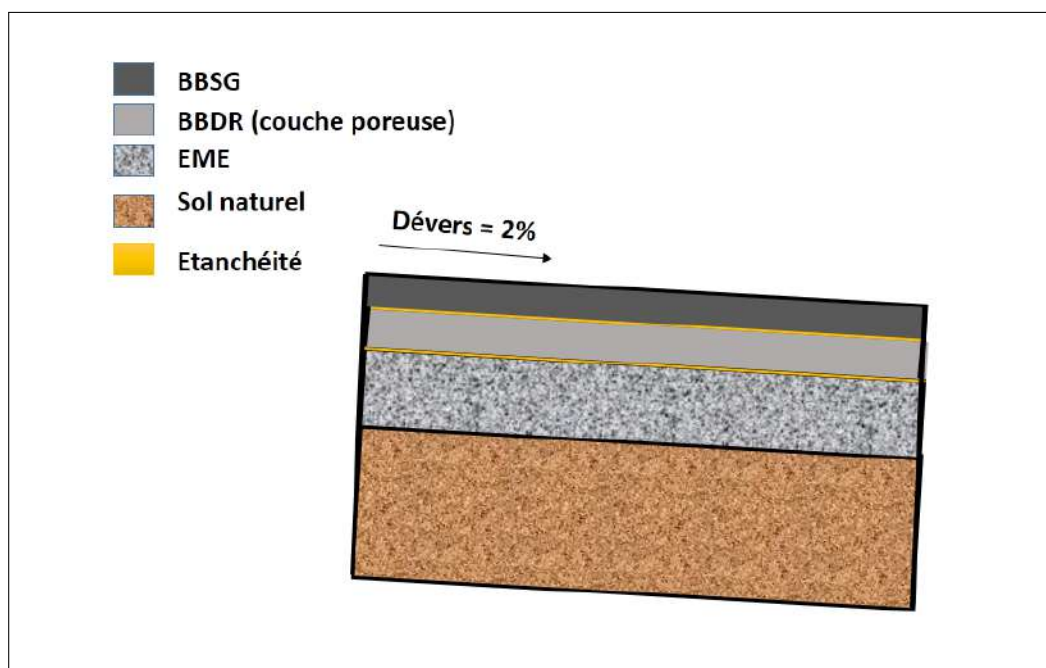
Les couches de la chaussée Dromotherm (coupe transversale)
